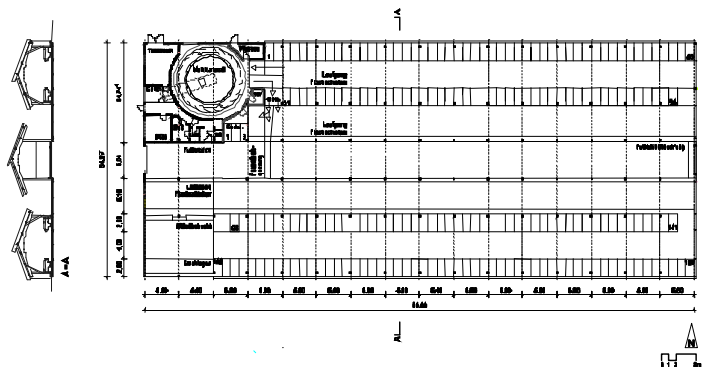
Betrieb MV 18 (Bayern) mit Ansicht, Grundriss und Schnitt
